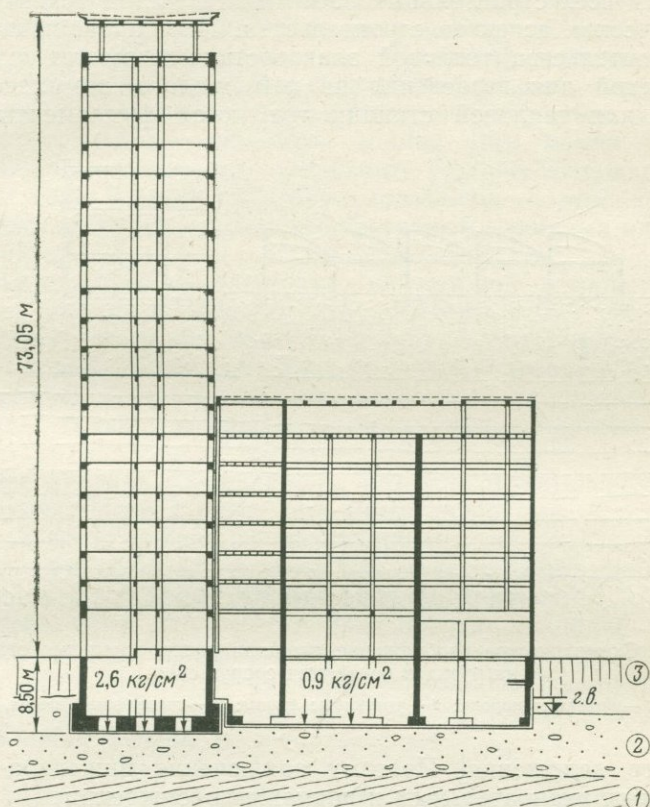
Высотное здание в Вене на коробчатом фундаменте [155].
